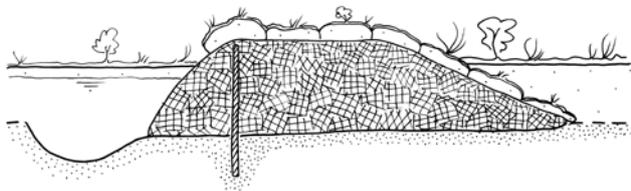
Längsschnitt des Dammes, der mit den zuvor beiseite gelegten Plaggen abgedeckt wurde
